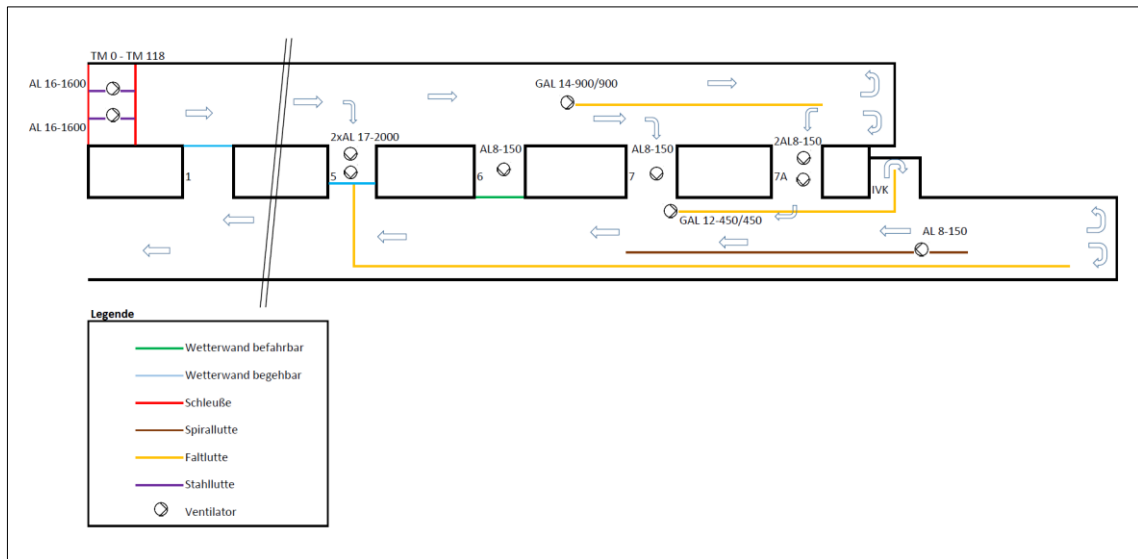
Grundriss Umluftsystem Tunnelabschnitt Gloggnitz Phase 2
